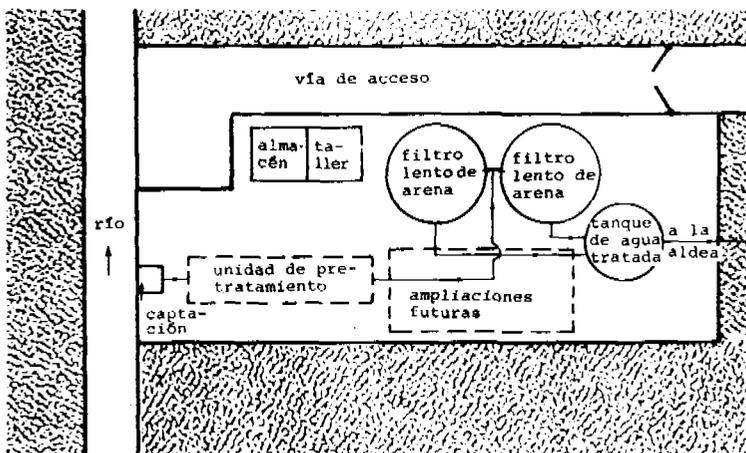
Esquema de planta de tratamiento que comprende el diseño típico No. III
